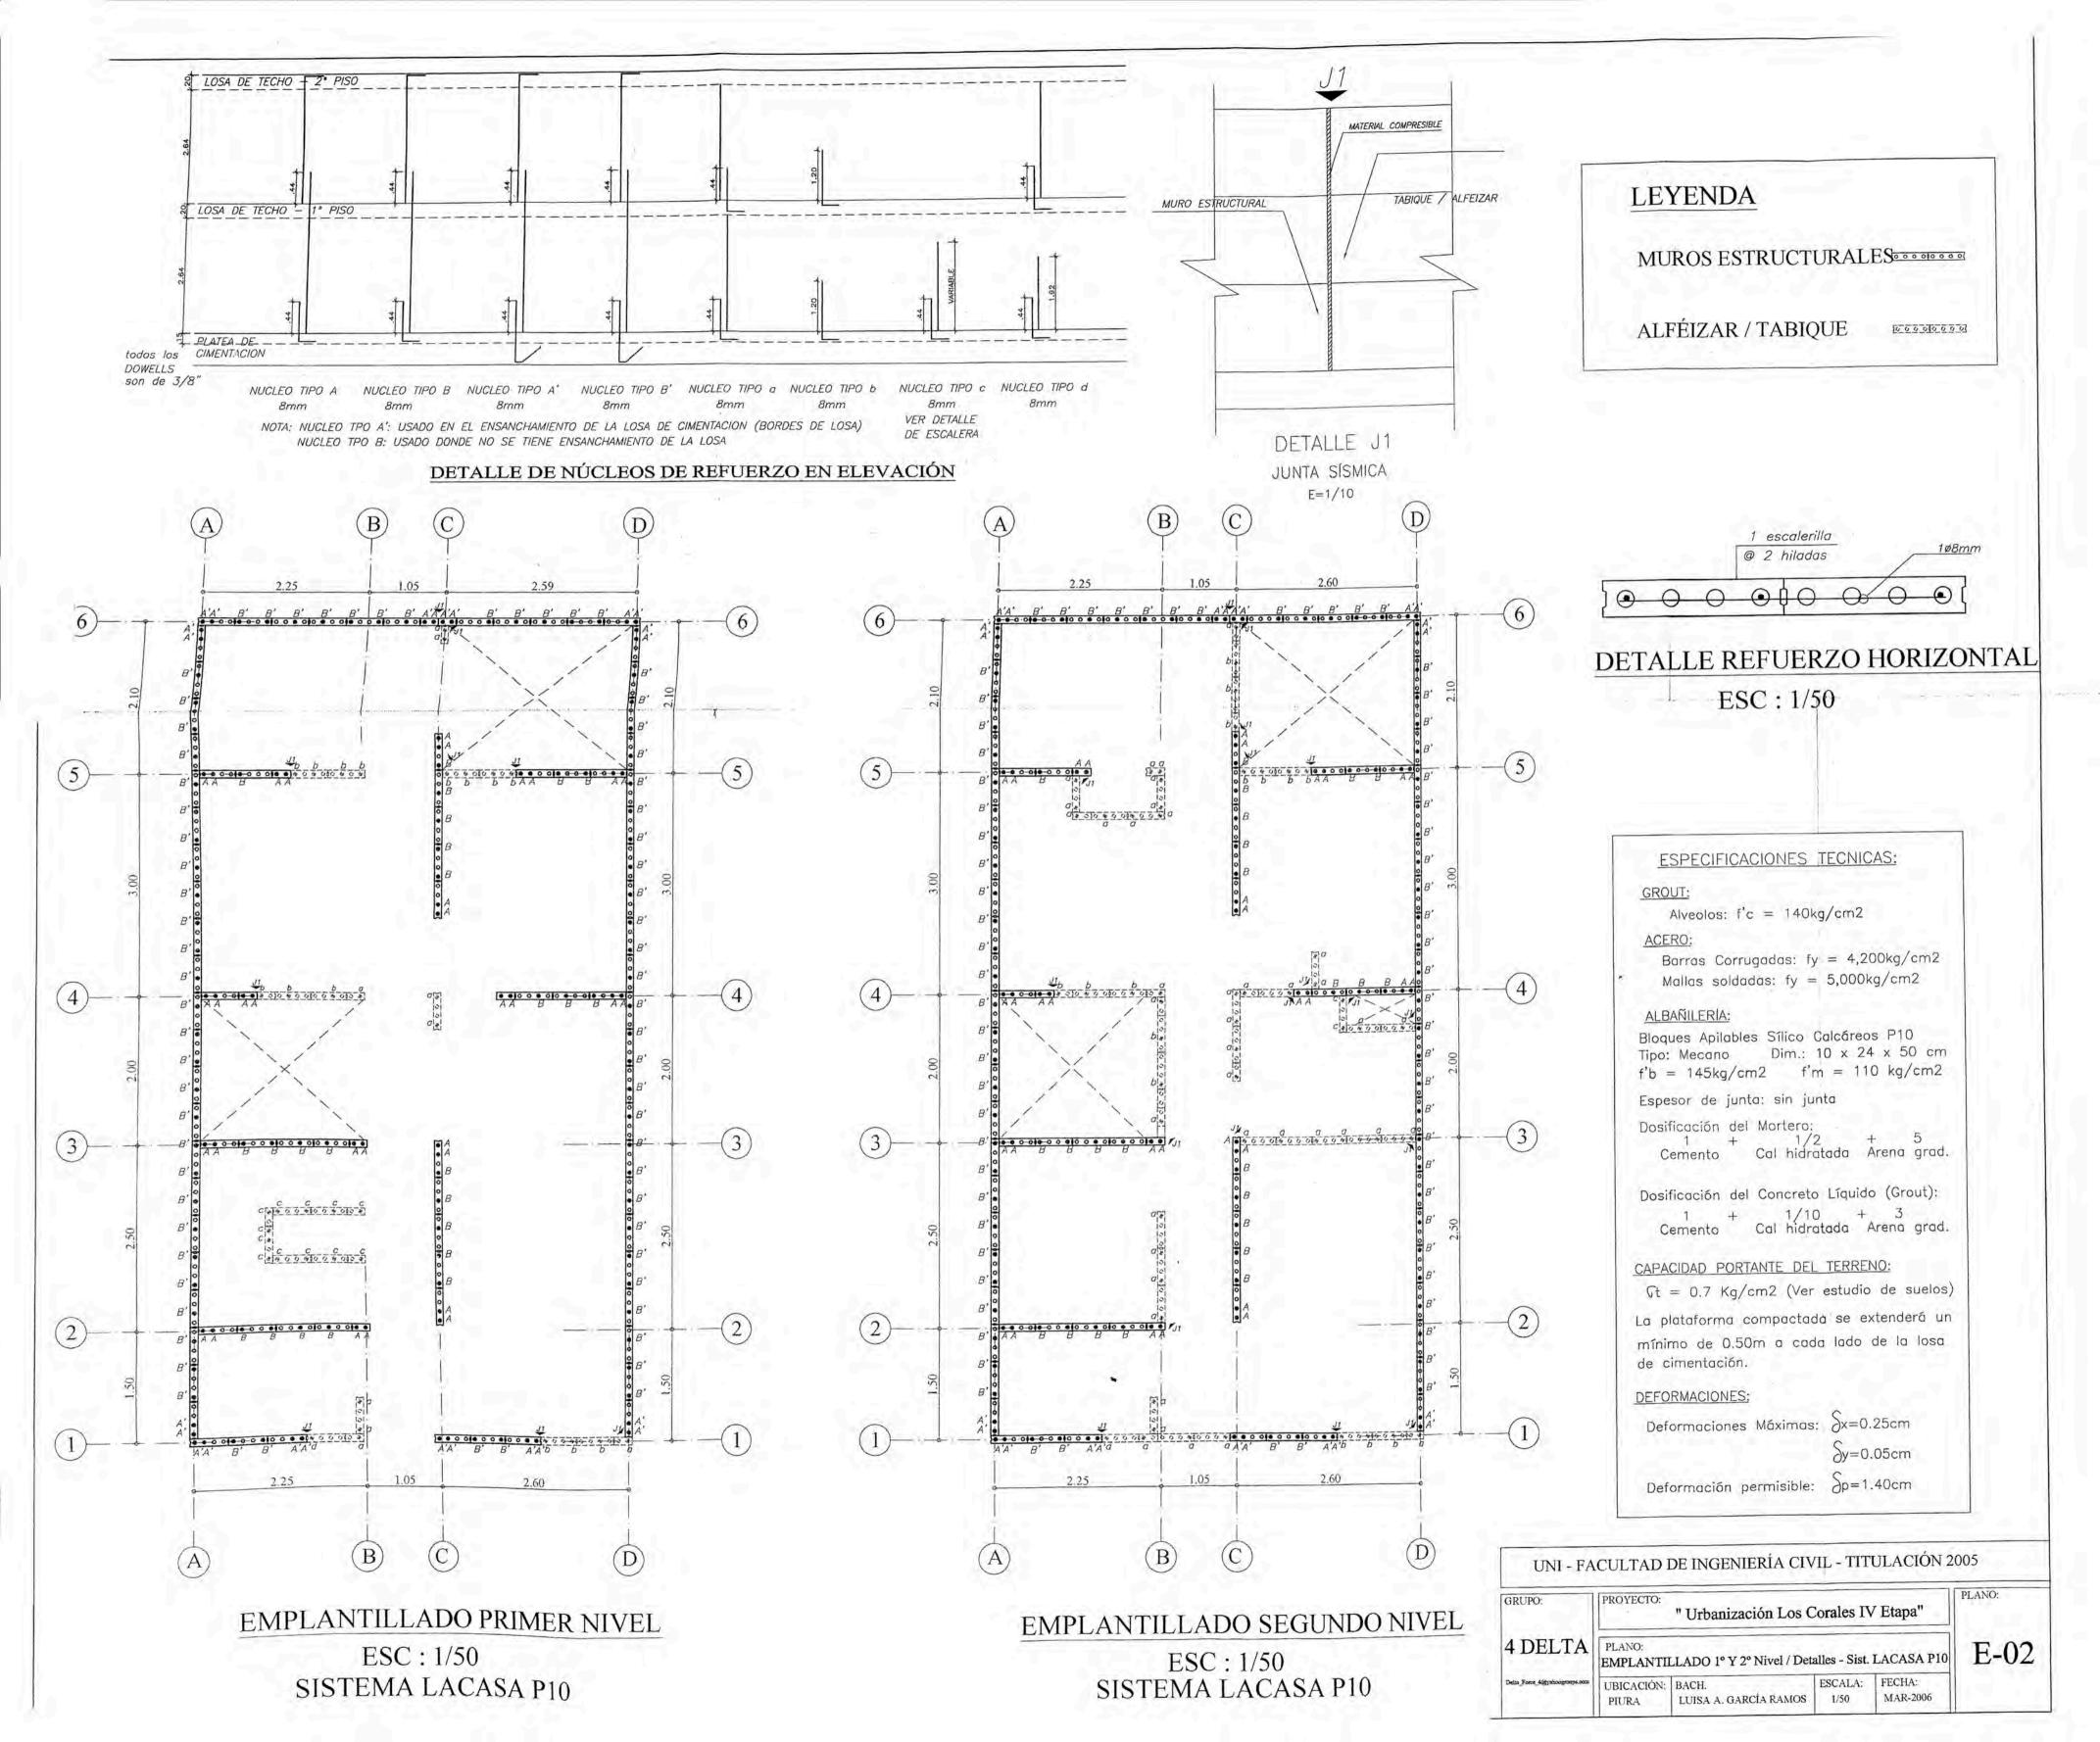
PLATEA DE CIMENTACIÓN / Detalles - Sist. LACASA P10
